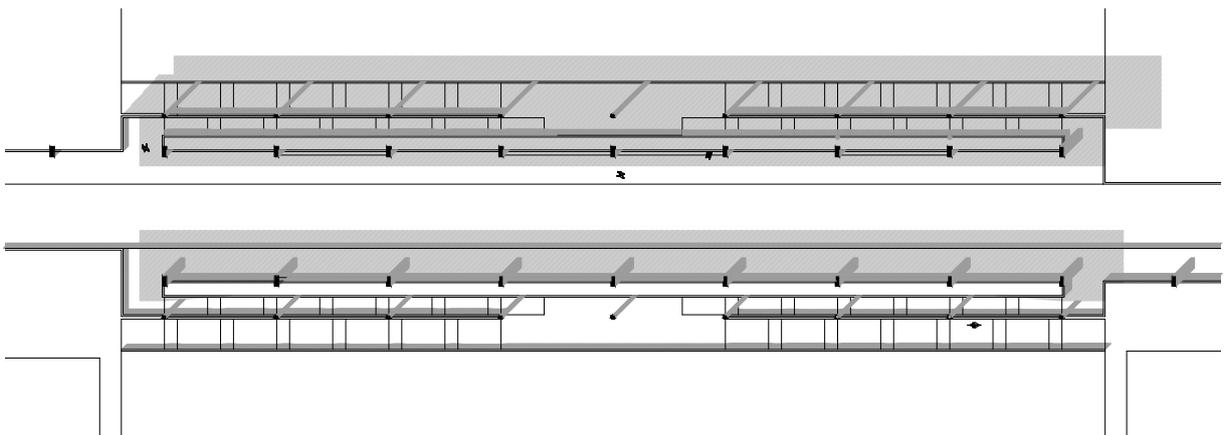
Planta ao nível do apeadeiro, redução da escala 1/200. Elaborada pelo autor.
